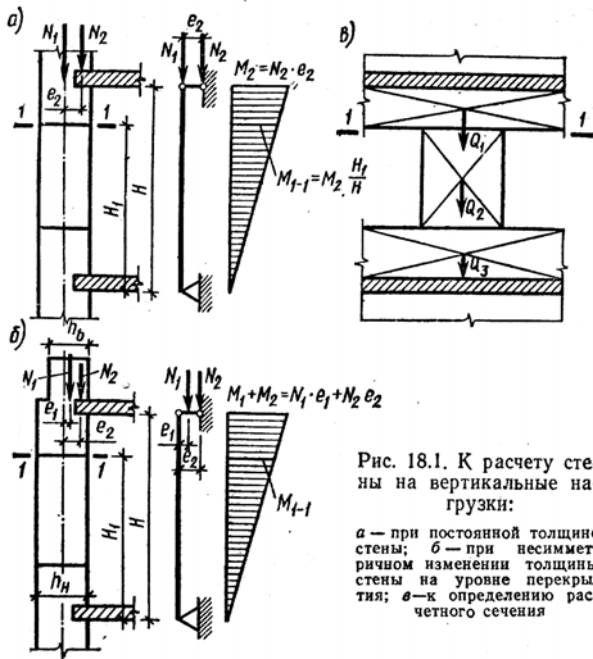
К расчету стены на вертикальные нагрузки:
